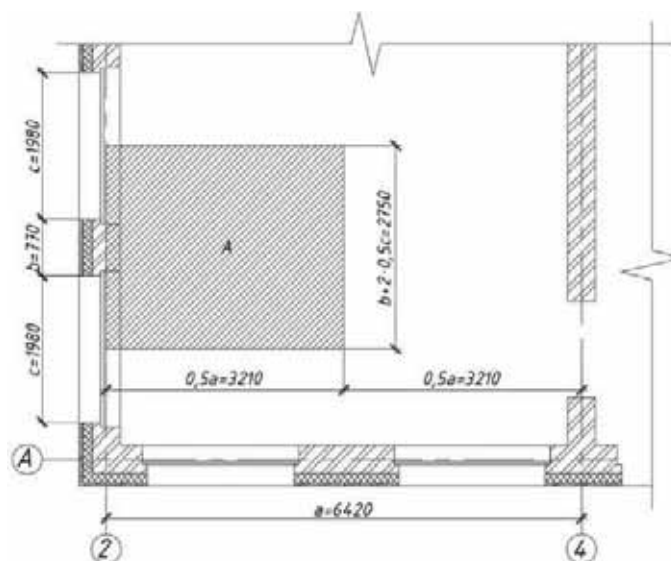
Определение грузовой площади покрытия (перекрытия).
